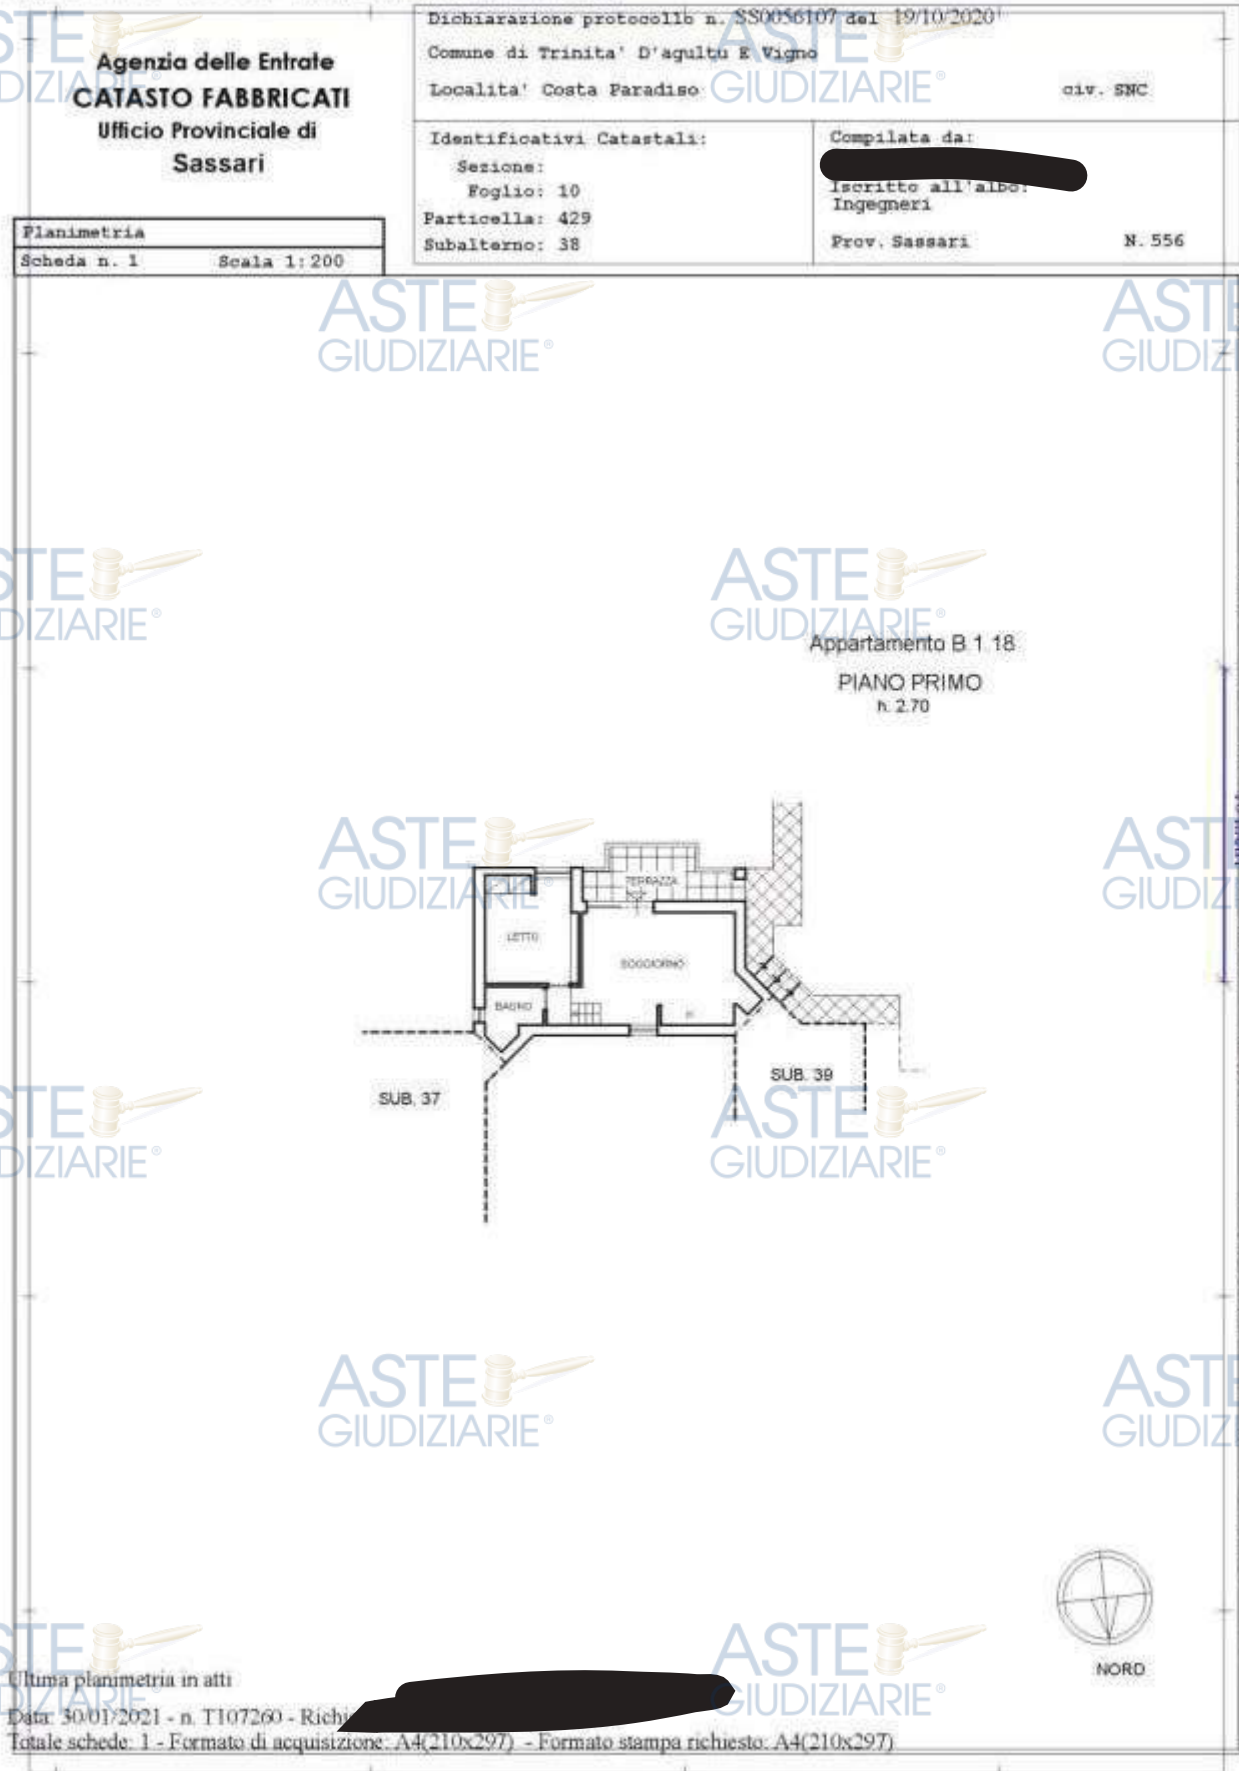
Visura planimetrica catastale aggiornata Fig. 10 Part. 429 Sub 38
